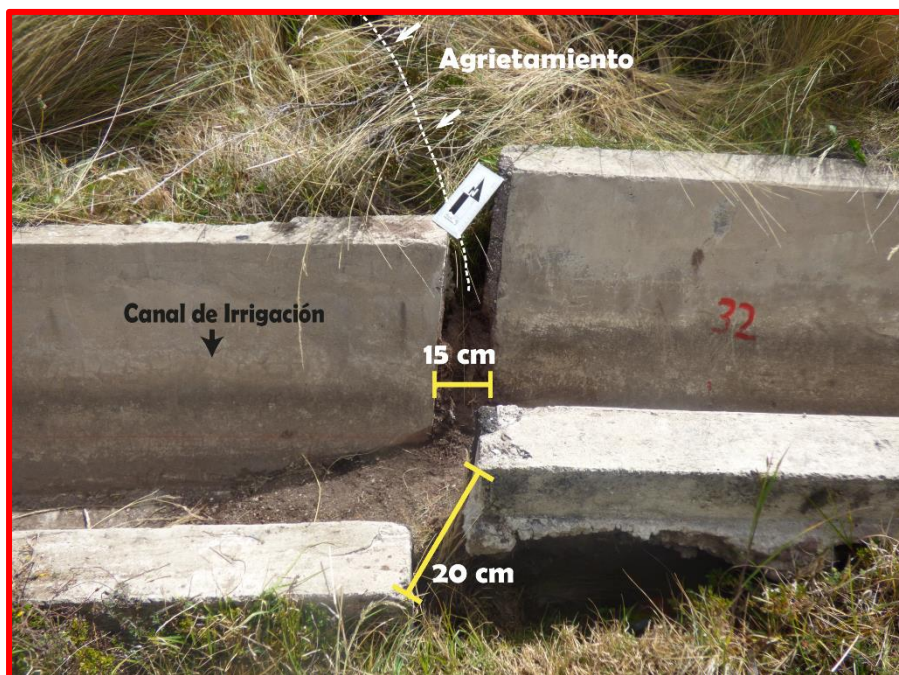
Desplazamientos y aperturas de la infraestructura del canal.
